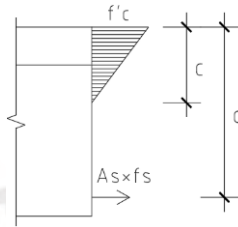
Distribución triangular de presiones en sección del aligerado de concreto armado.
